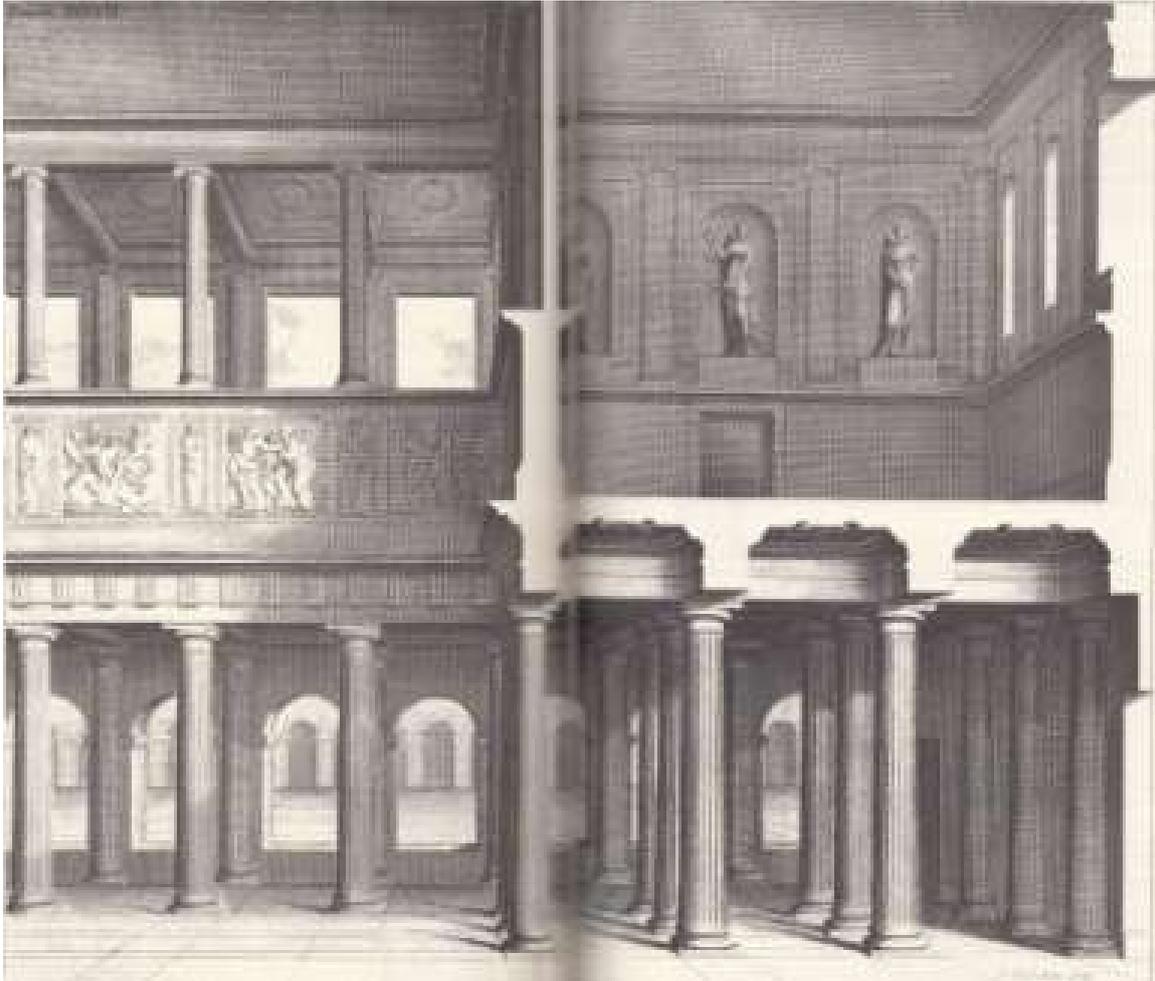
Planche XXXVIII Vitruve 1673.⁹¹
